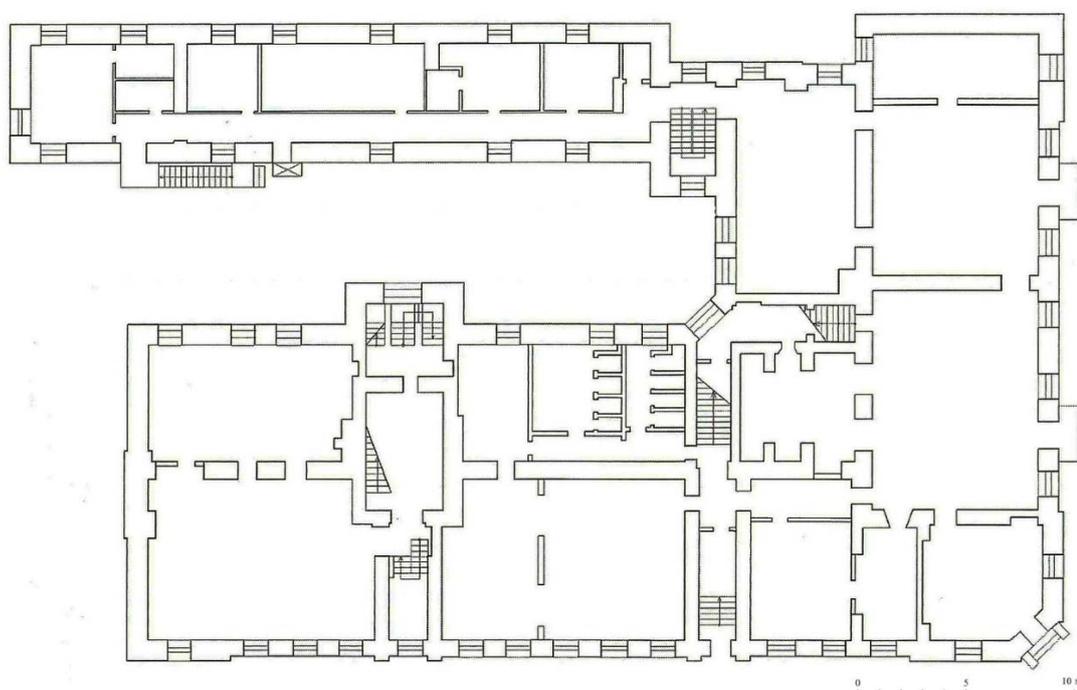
Здание доходного дома Плюсниных. План первого этажа
